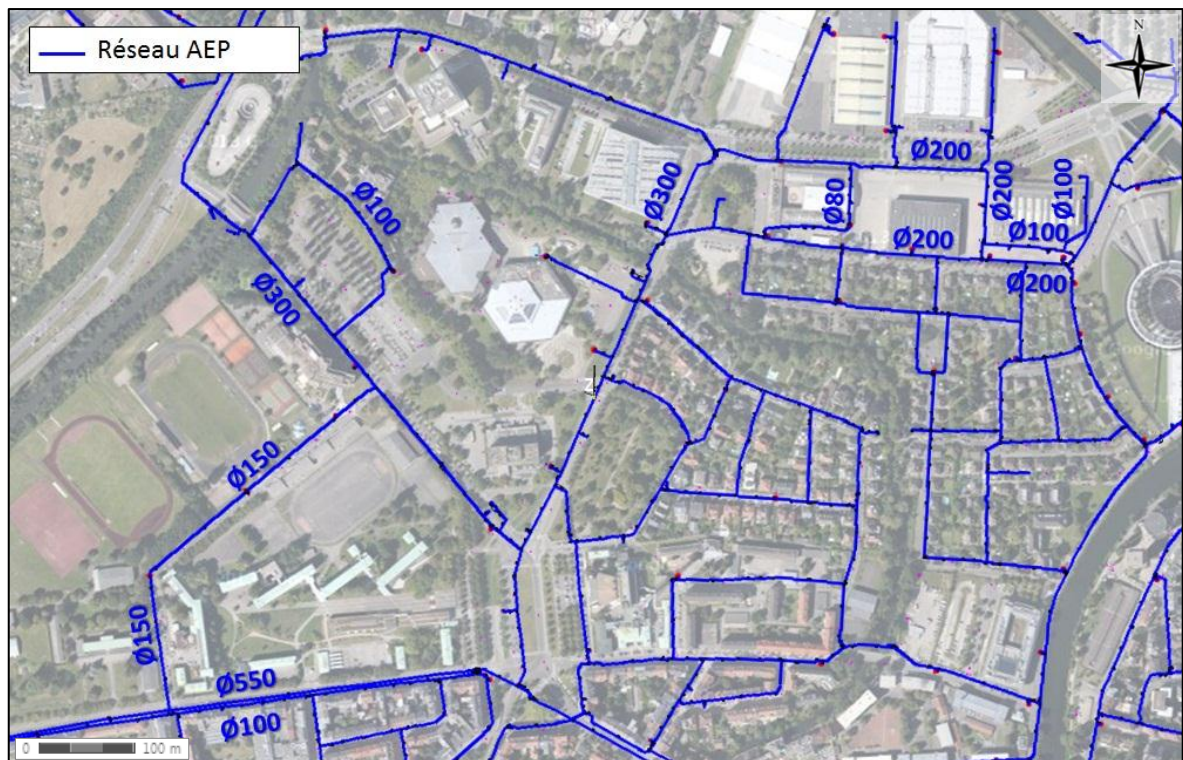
Réseau d'eau potable : plan général (d'après plans CUS)
